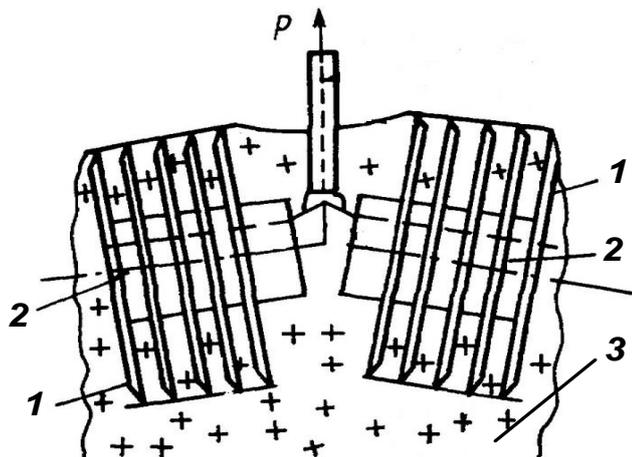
Устройство для удаления с поверхности аэродромных и твердых покрытий ледяного и снежного накатов
